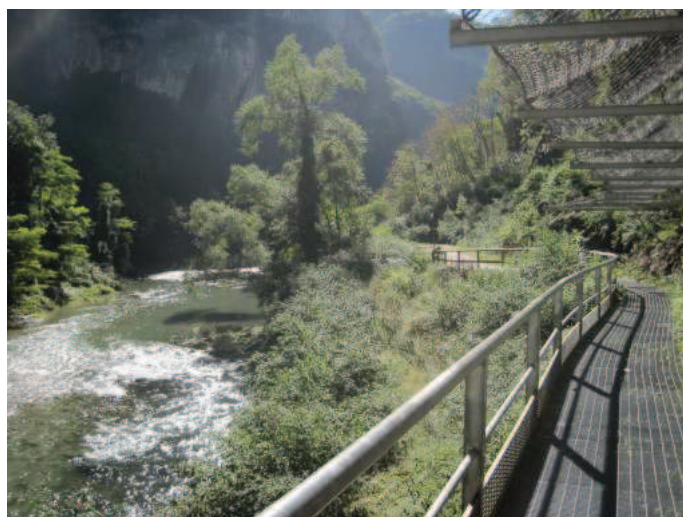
Passerella a sbalzo su parete rocciosa
